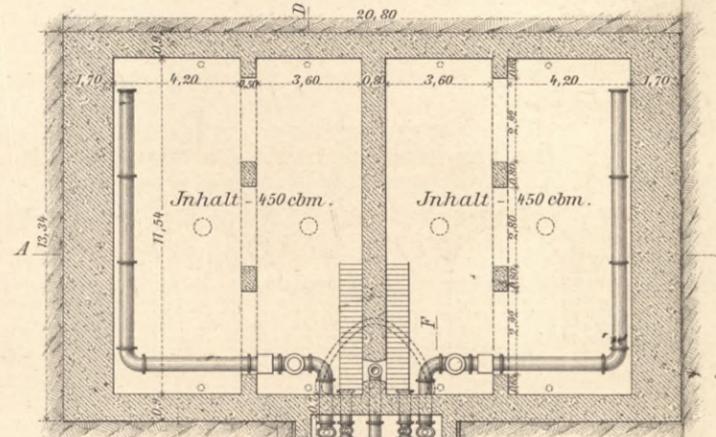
<sup>a u b</sup> Gasbehälter zu Nürnberg (Stampfbeton). M. 1:500.
